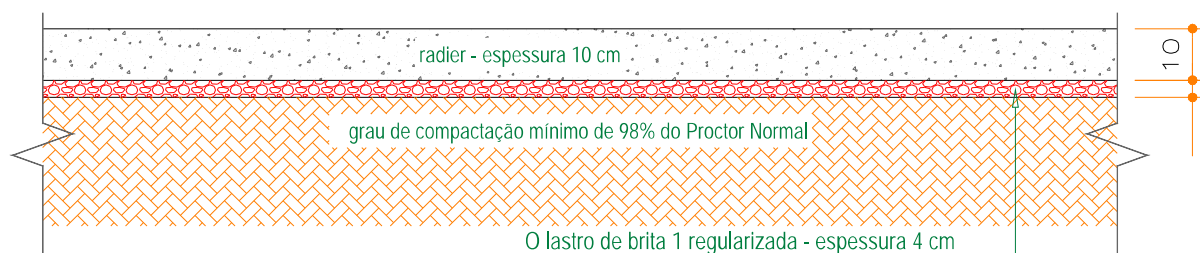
Corte genérico da seção transversal do conjunto *radier*/lastro de brita/terreno natural, corte ou aterro.
